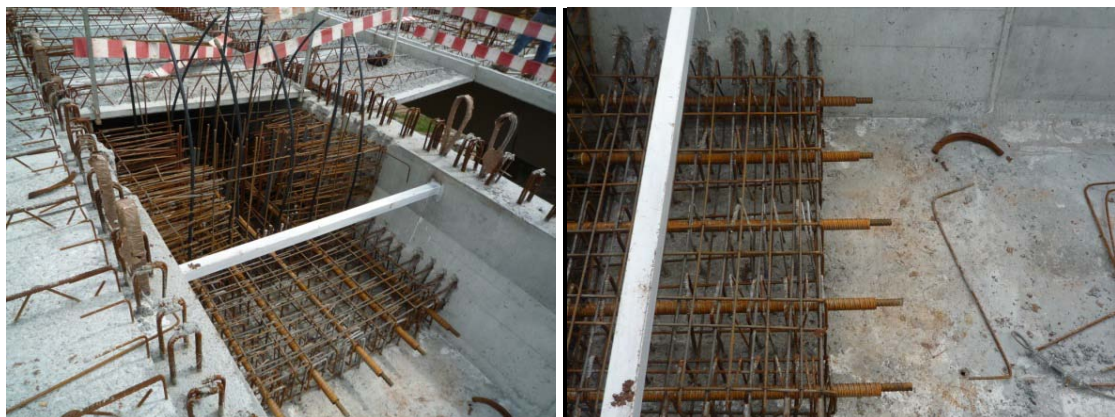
e 57: Diafragma a betonar com pré-esforço em barra
